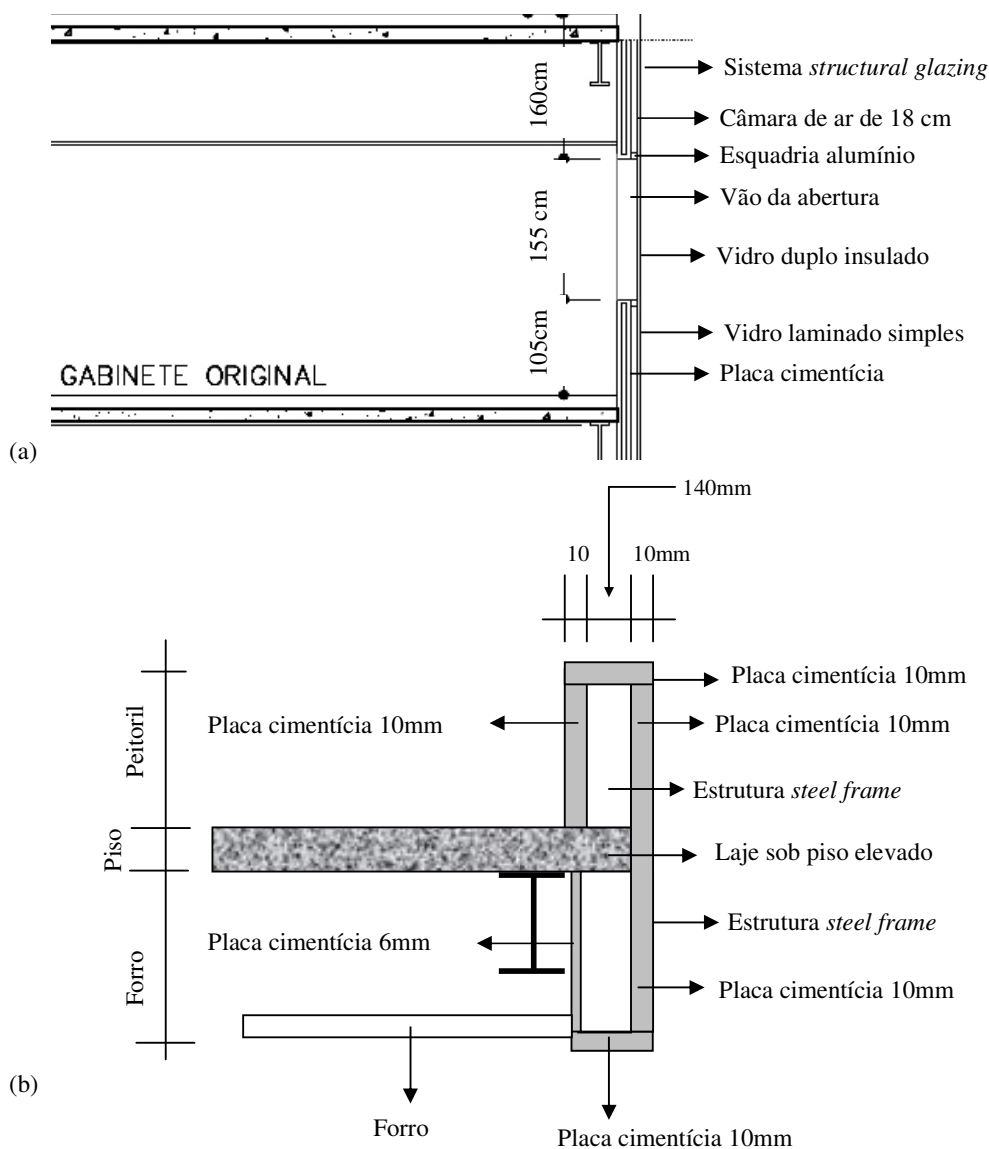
Corte parcial do ambiente em análise (Gabinete) destacando: (a) o sistema de fachada original, em cm; e (b) o sistema de placa cimentícia, em mm. Ambos sem escala. Fonte: Adaptado a partir de arquivos do TJMG.
